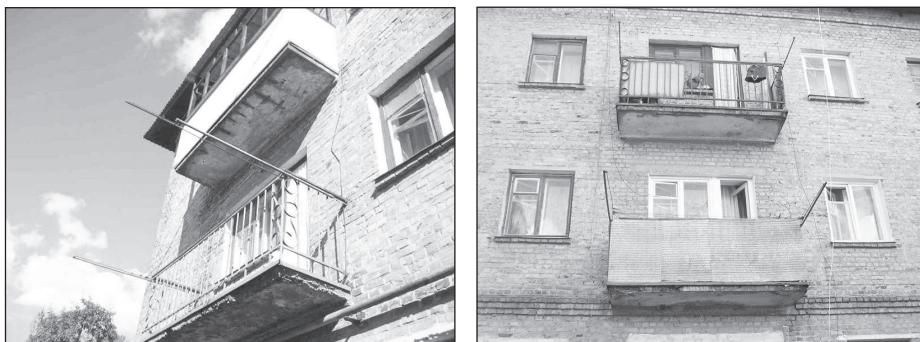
Фрагменти фасадів будинку з пошкодженими балконними плитами
